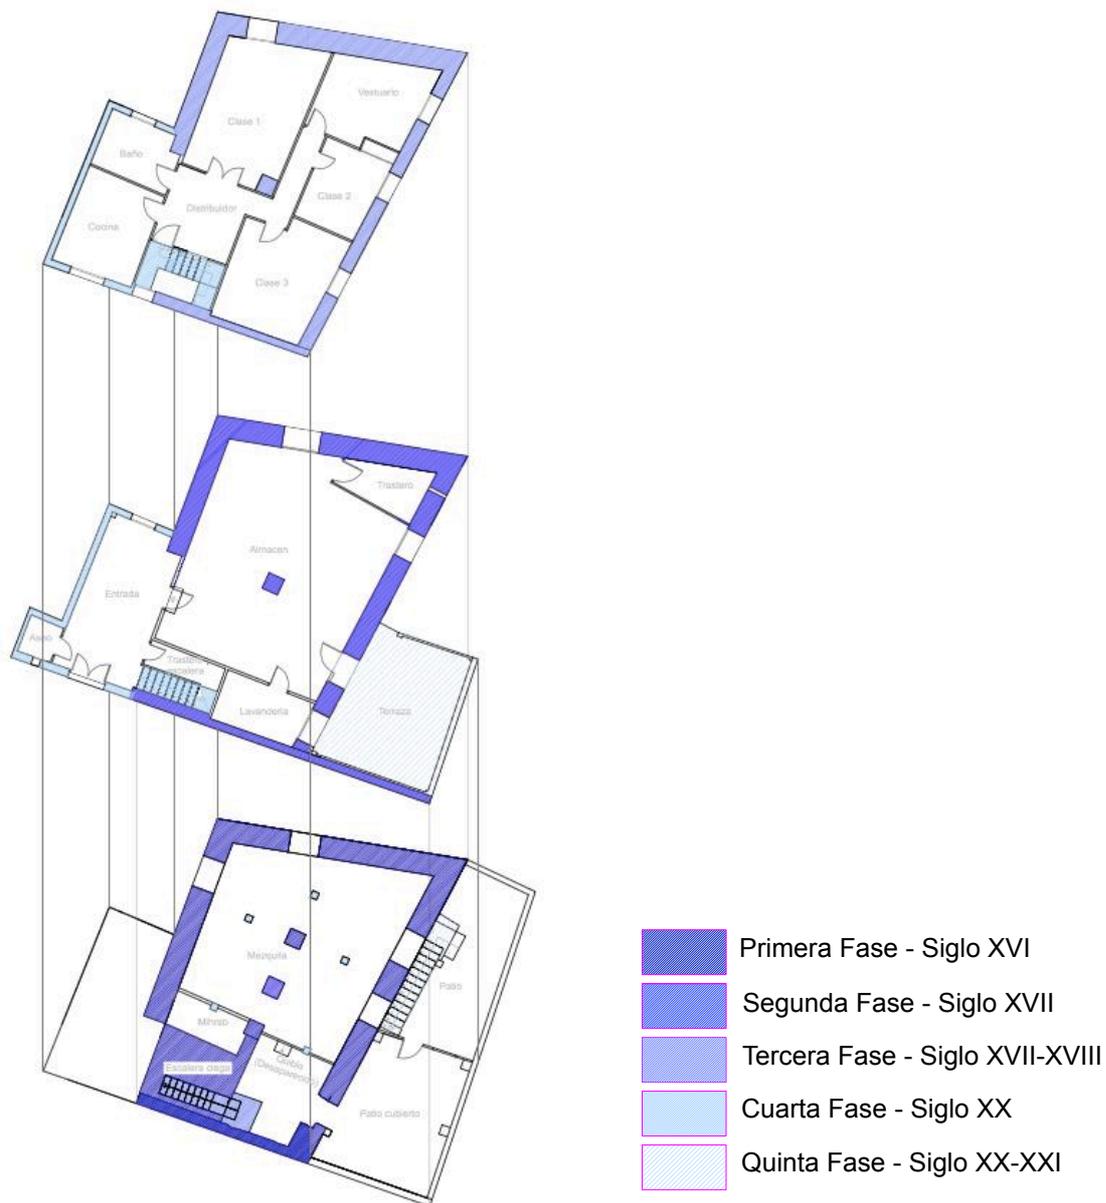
Fases de construcción. 20017. Plá Gutiérrez, Iván.
